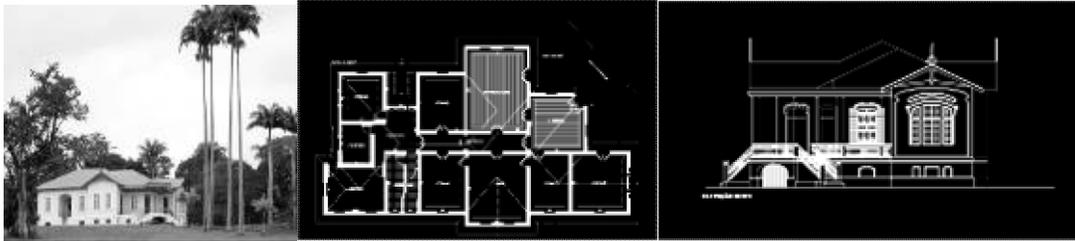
, 15, 16 - Sede, planta principal, elevação oeste. Fazenda São Vicente em Campinas-SP
